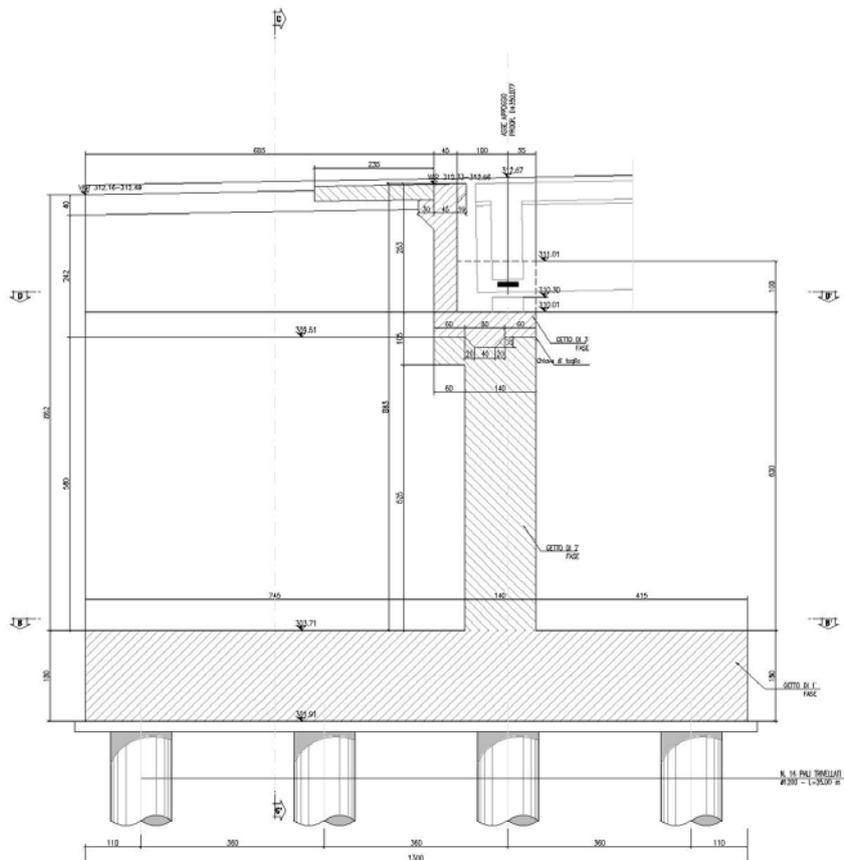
Sezione longitudinale spalla A.
